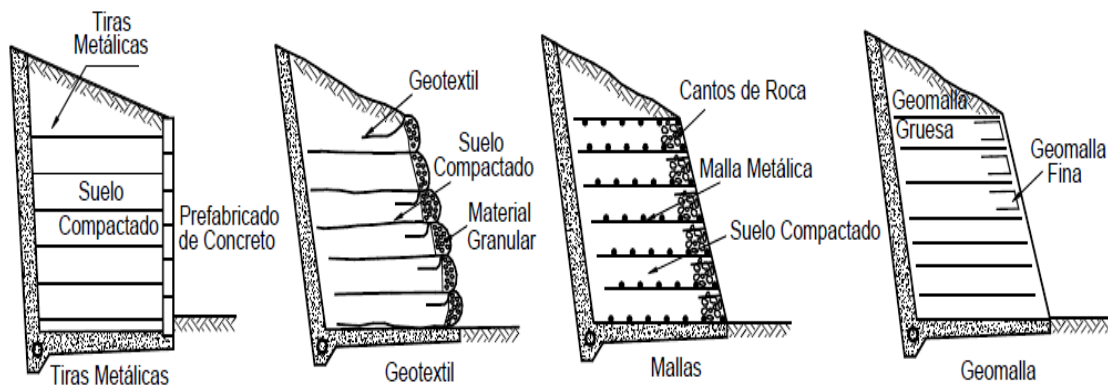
Tipos de Refuerzo para muros de suelo reforzado (JAIME SUAREZ, 1996).
